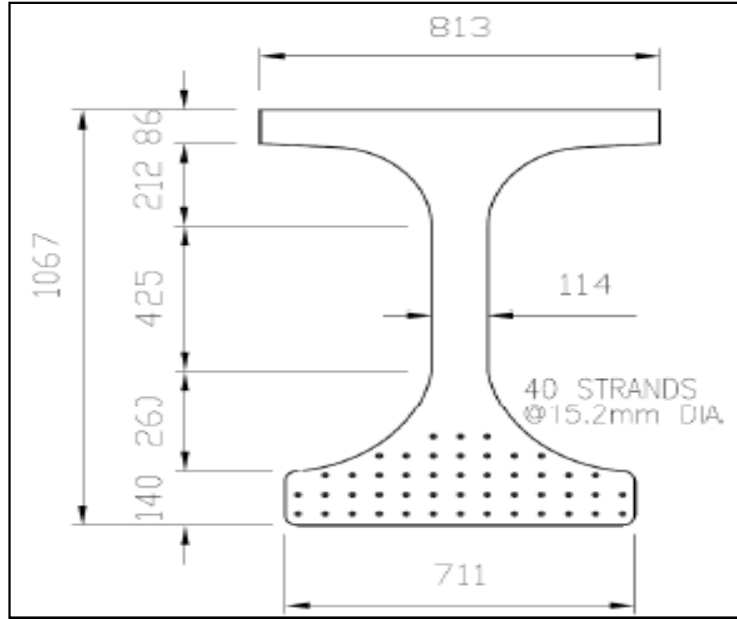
Shepherds ırmağı üzerindeki, RPB kullanılarak yapılan ilk araç köprüsü kirişi [33]
